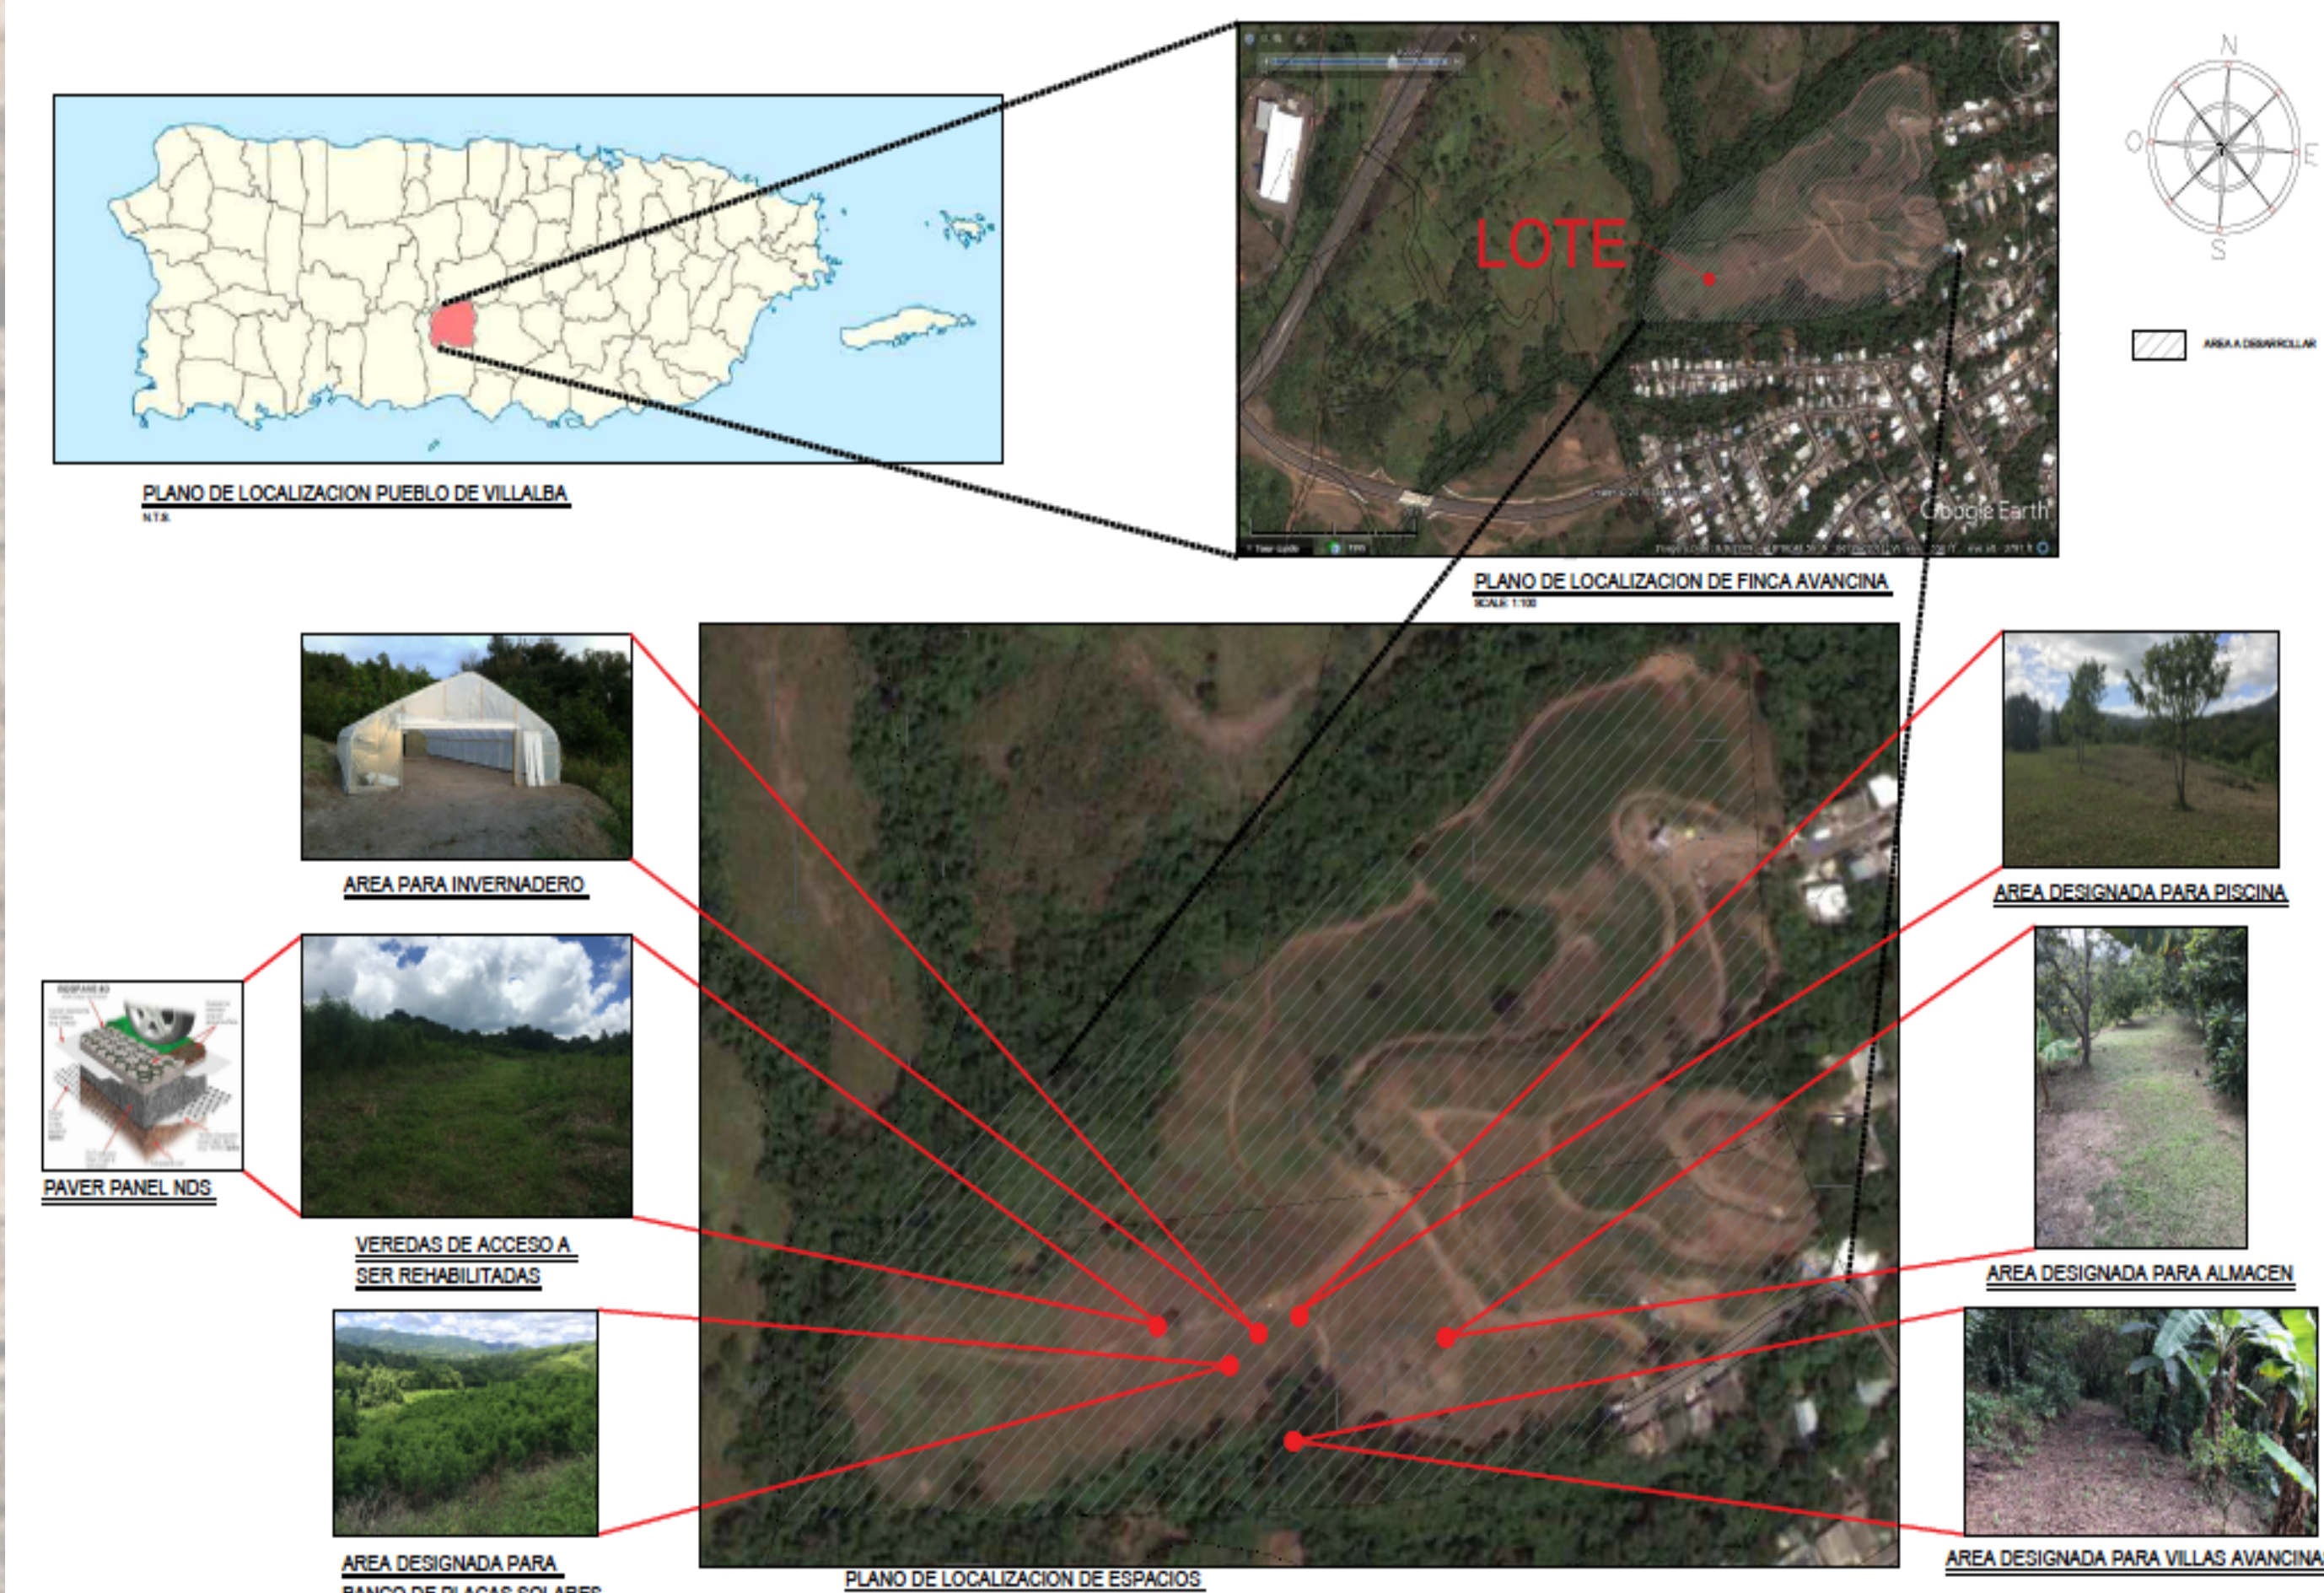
Zona de ubicación de la finca y distribución de amenidades propuestas
